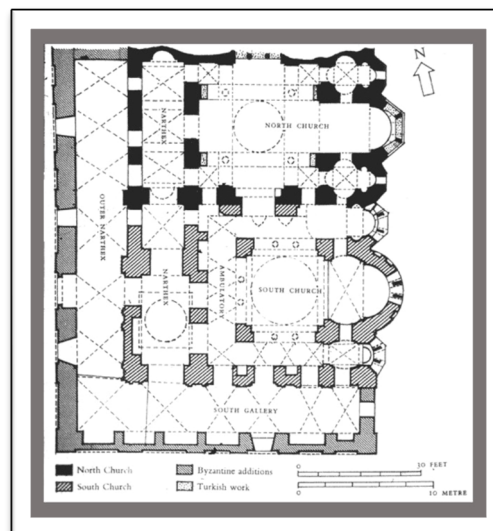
Planta de las dos iglesias: septentrional (del año 907) y meridional (posterior a 1282)
